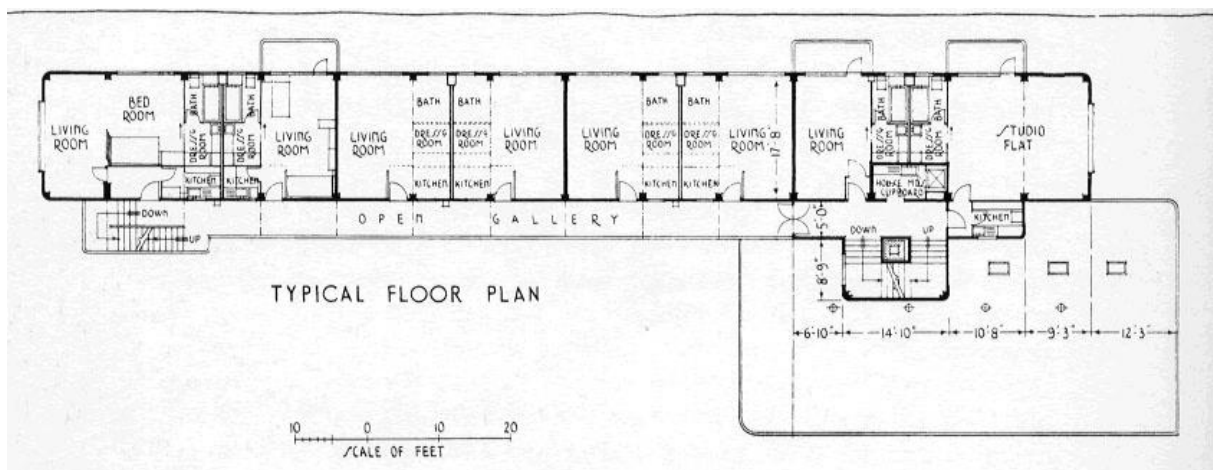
Pavimento tipo, Edifício Isokon, Wells Coates, Londres, 1934
